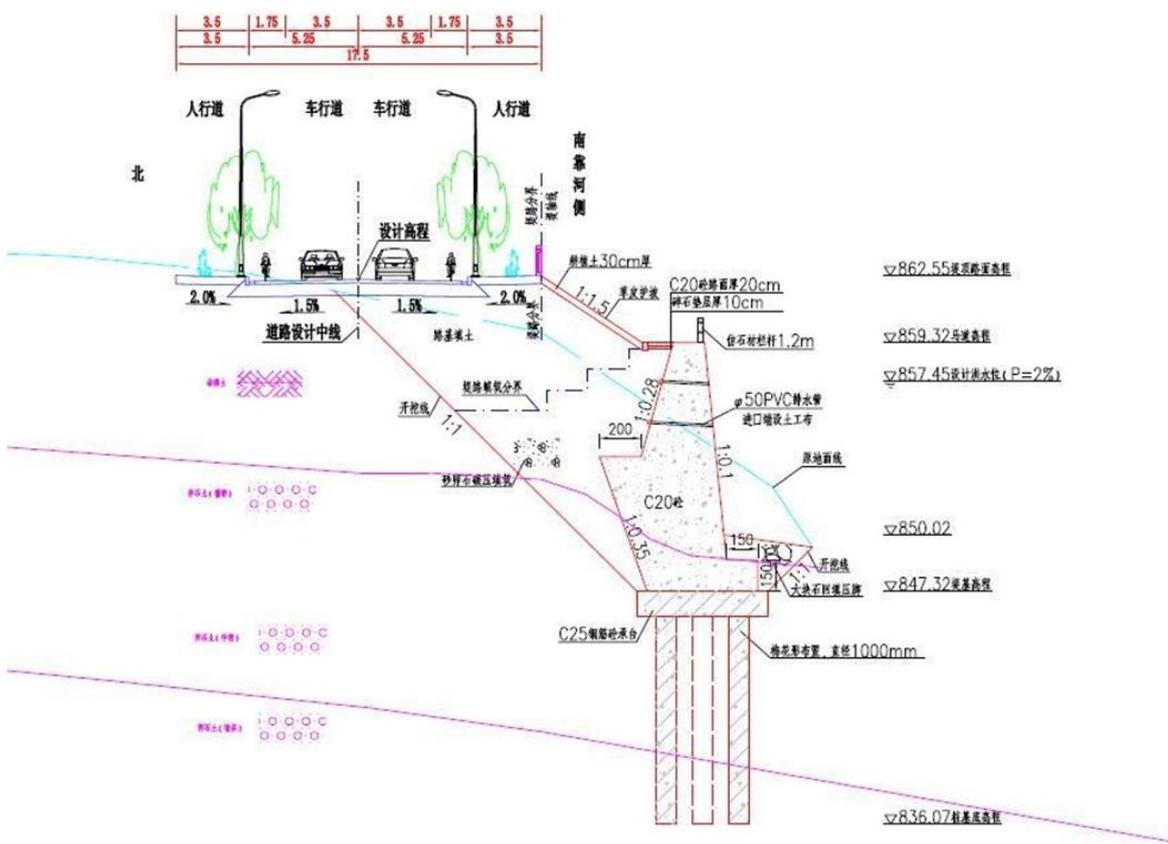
岩子路及河堤典型横断面图示意图（图中尺寸以 m 计）
